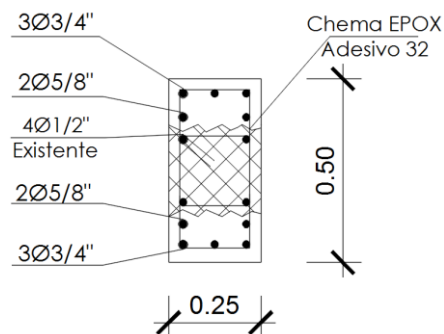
Refuerzo de columna de 25x25 a 25x50 cm^2 .
